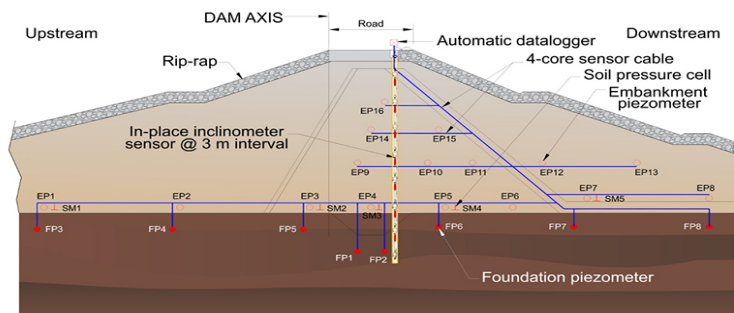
Esquema de Instrumentação Típico – Barragem de Terra: Perfil longitudinal de uma barragem de terra e instrumentação associada. (Adaptado de Encardio-rite, 2021)
